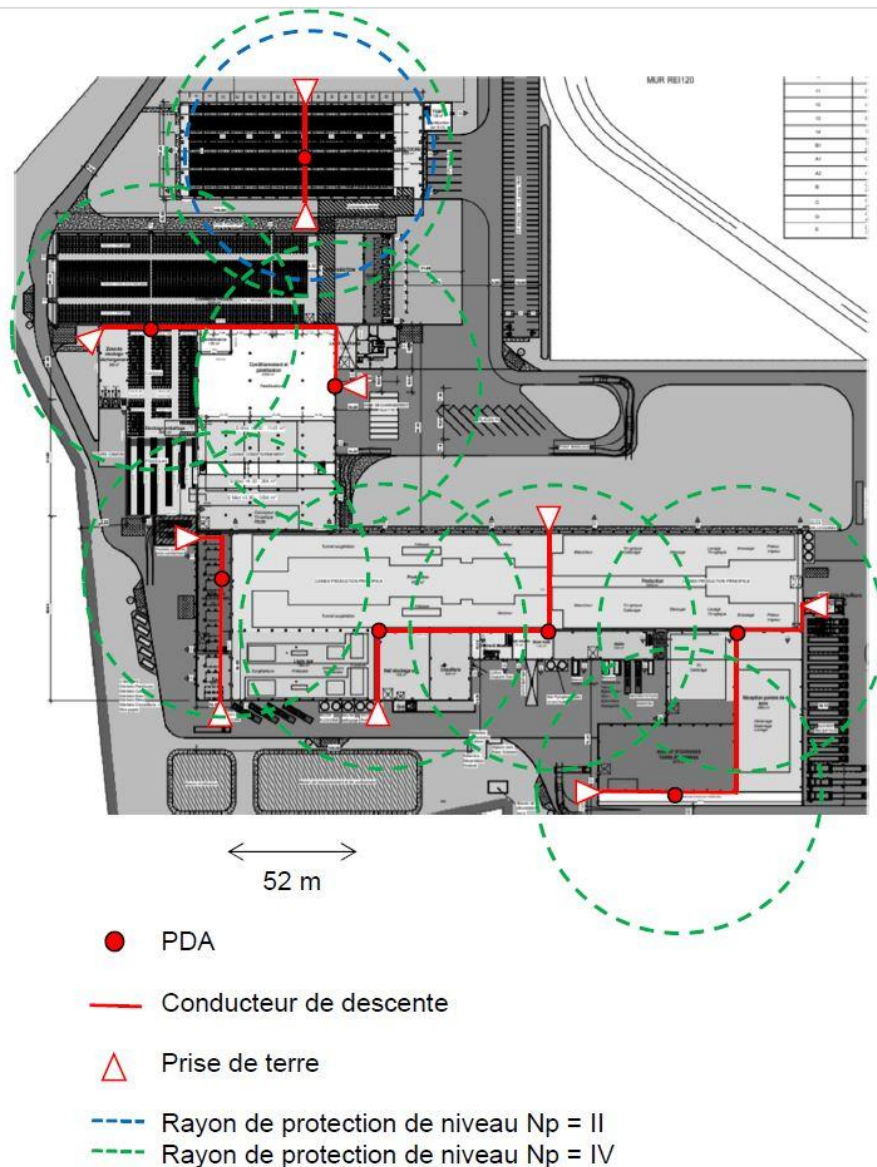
Plan projeté des installations extérieures de protection foudre (source : *Etude BCM Foudre, disponible en annexe C-1*)
